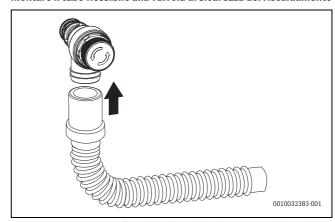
Montare il tubo flessibile alla valvola di sicurezza del riscaldamento
